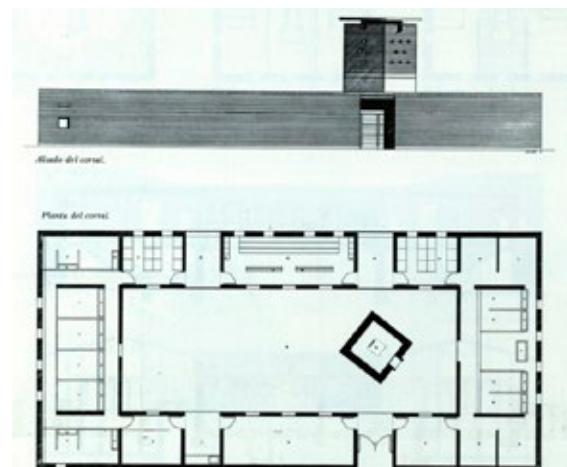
Planta y alzado del corral, Granja Residencia en Villatobas, (Riviere Gómez, 1982).
